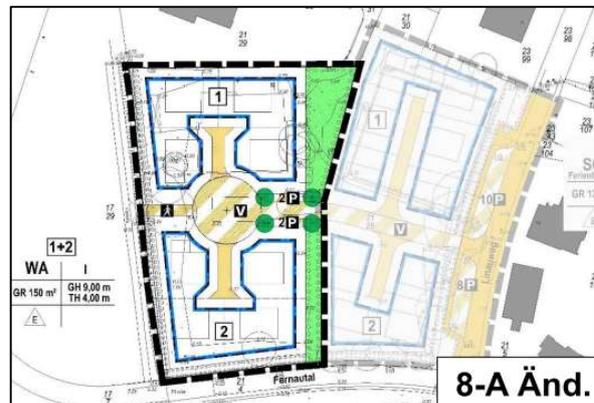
Entwurf 8a. Änd. B-Plan Nr. 15 (Blank, 2020)
